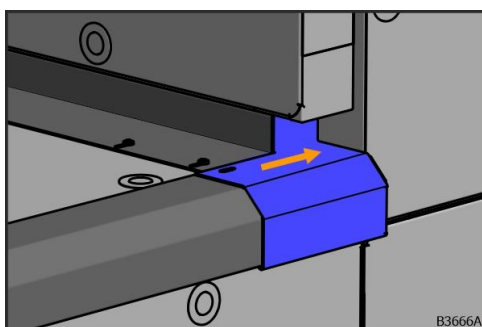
Compression de l'extrémité de la cornière casse-goutte
